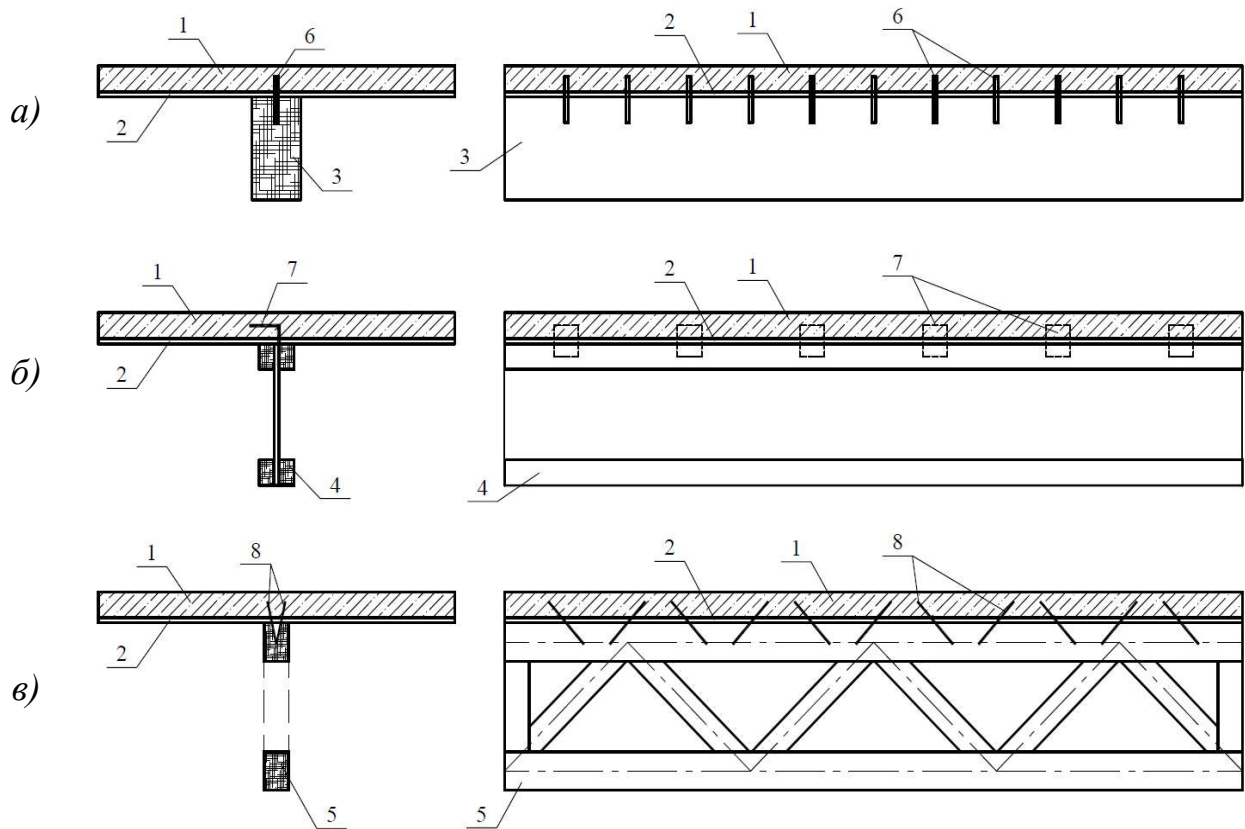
Варіанти конструкцій другорядних деревобетонних балок:
